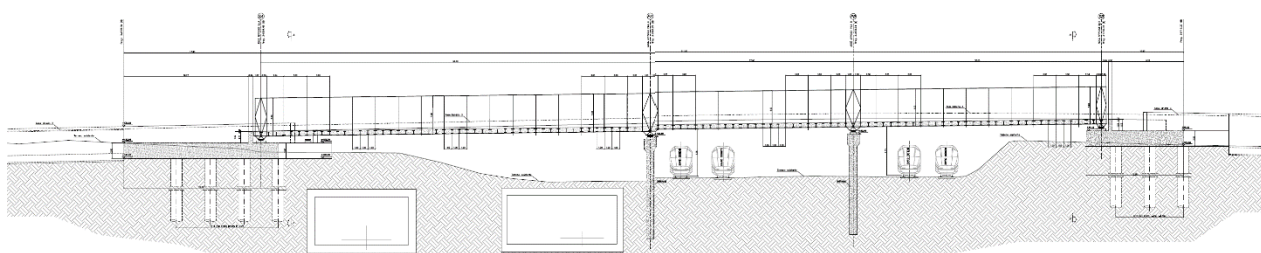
Sezione in asse manufatto di scavalco su linea RFI.
